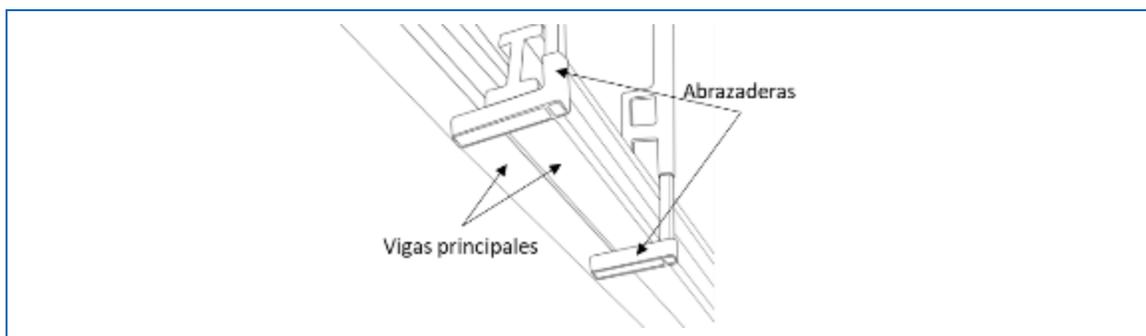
Vista inferior de unión de pilares verticales con las vigas principales del encofrado – Elaboración Propia
